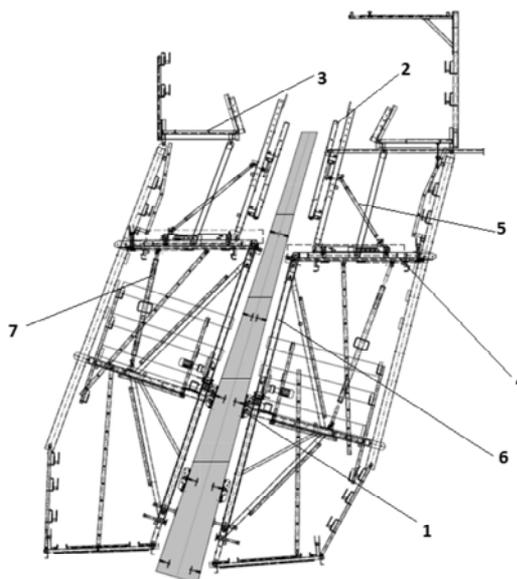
Схема подъемно-переставной опалубки «ДОКА SK175»: 1-опорные катки; 2-щиты опалубки; 3-рабочая площадка; 4-подвесные подмости; 5-распалубочный шпindel; 6-внутренняя стойка рамы; 7-домкратный стержень.
